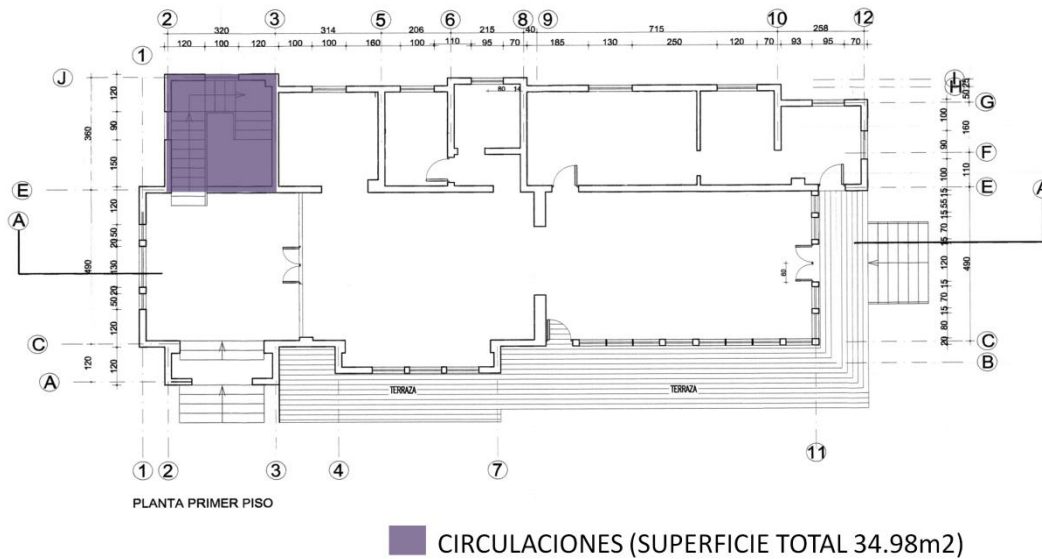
Planta Primer Piso Casona Ex Sporting
